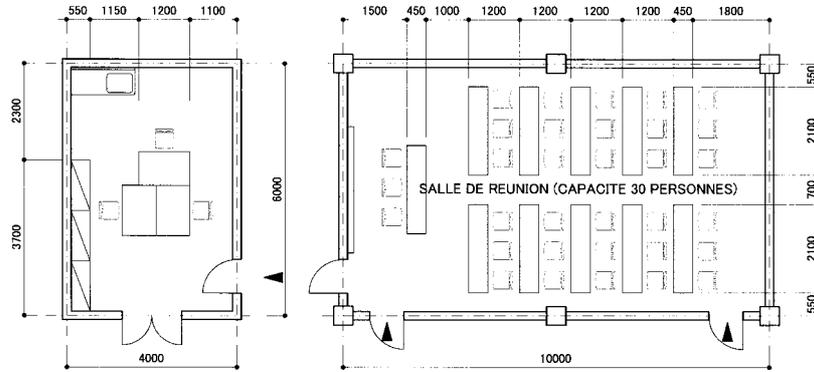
Plan planimétrique de la salle de réunion et du bureau du comité de gestion
